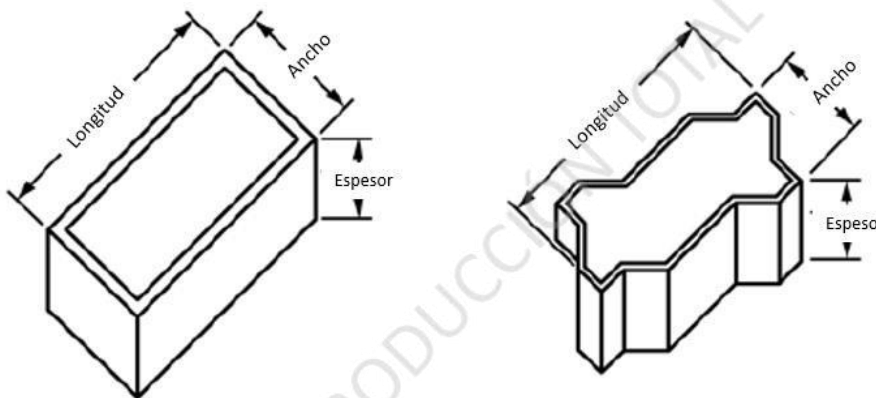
Longitud, ancho y espesor de las unidades de concreto para pavimentos
